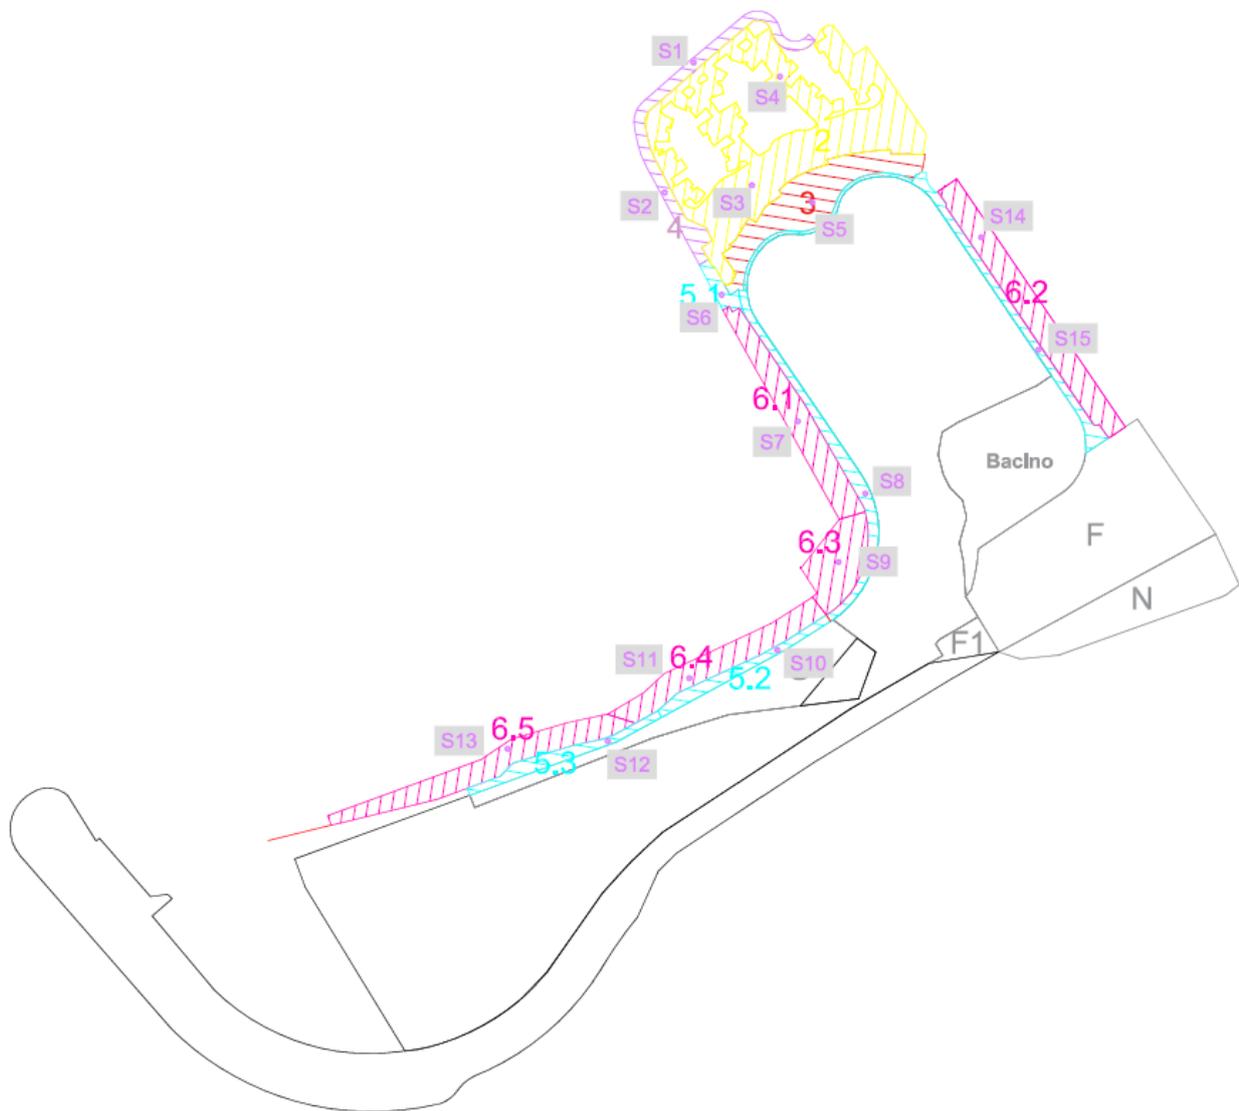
planimetria con proposta di ubicazione dei punti di indagine
